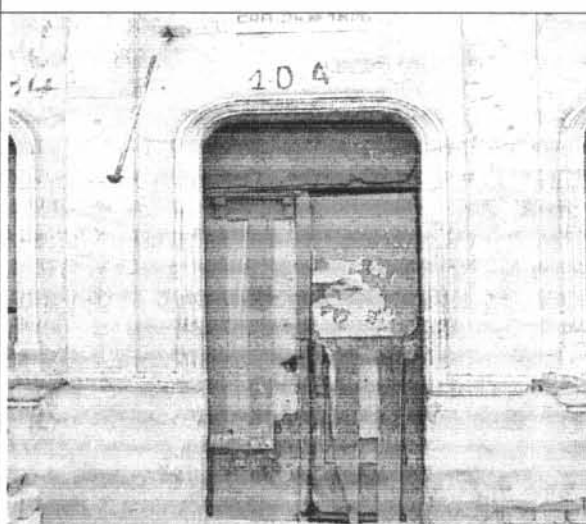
Muros fisurados y deterioro del inmueble
